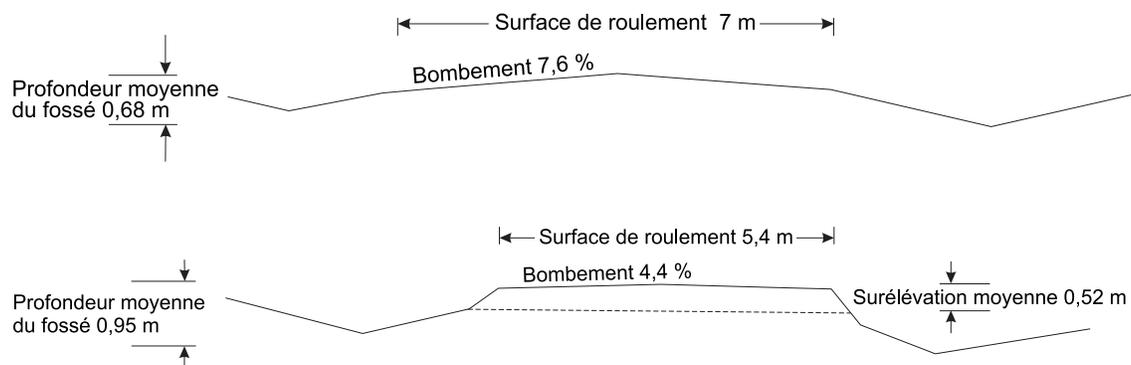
Profil transversal type d'une route à Fossé-V, telle que construite.
